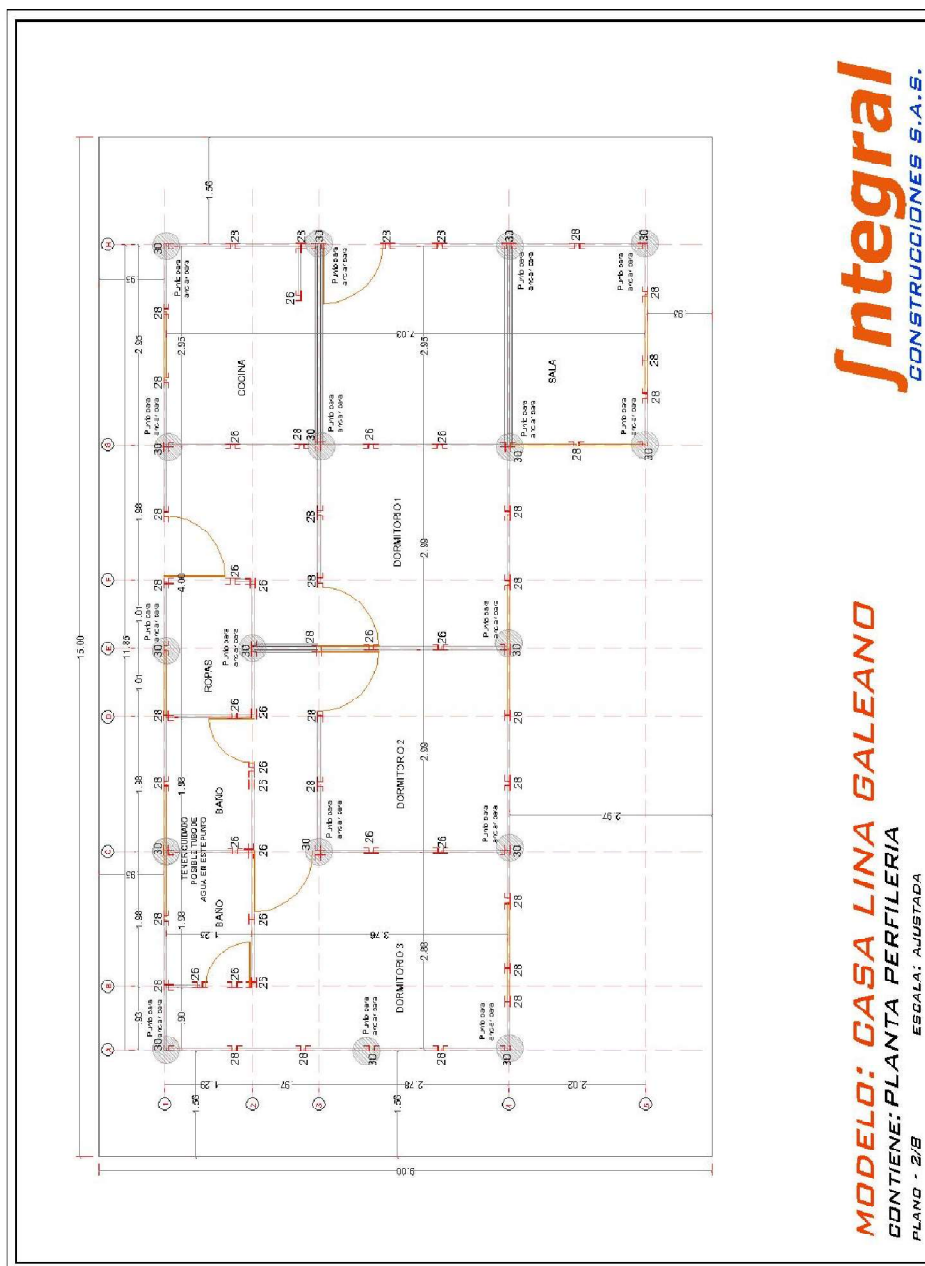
Plano arquitectónico vivienda Lina Galeano
